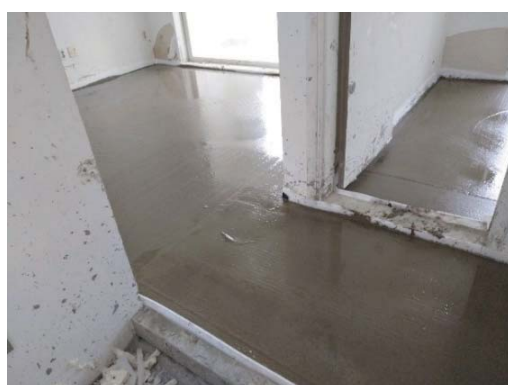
上階でのオンドル用モルタル施工中の様子（KICT）
